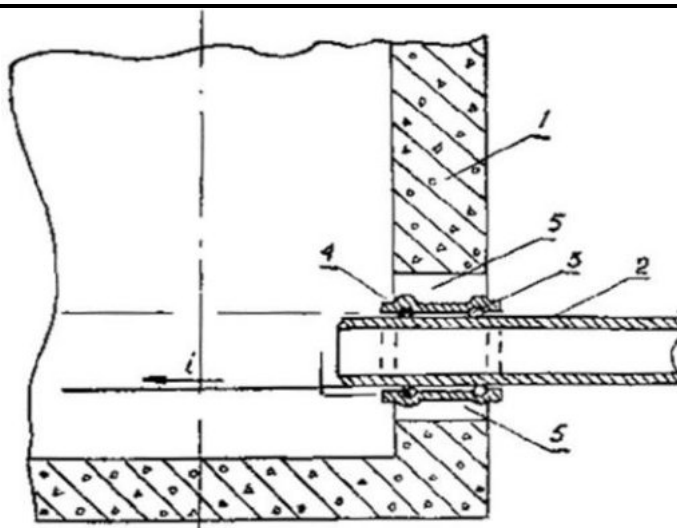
Проход самотечного трубопровода сквозь стенки колодца и другие строительные конструкции: 1 - железобетонная стенка колодца; 2 - труба из ПВХ; 3 - муфта из ПВХ; 4 - резиновое кольцо; 5 - заделка цементным раствором.
